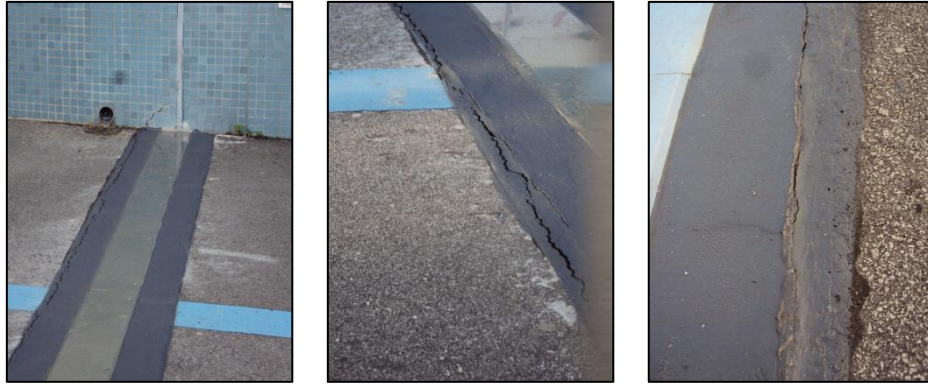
Fissuração da mástique de ligação do betão ao pavimento betuminoso.
